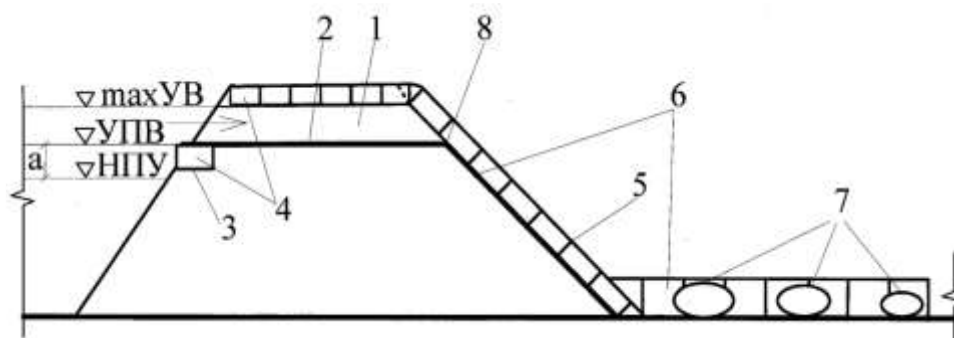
Схема резервного водосброса грунтовой плотины: 1 – искусственный проран; 2 – защитное покрытие из геомембраны; 3 – приямок со стороны верхнего бьефа; 4 – пригруз; 5 – двойное полотнище геомембраны; 6 – гибкая оболочка из геомембраны с песком; 7 – гасители энергии водного потока; 8 – сварной шов
